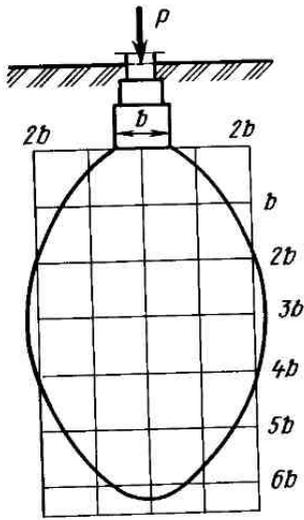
Напряженная зона грунта основания под подошвой фундамента:
